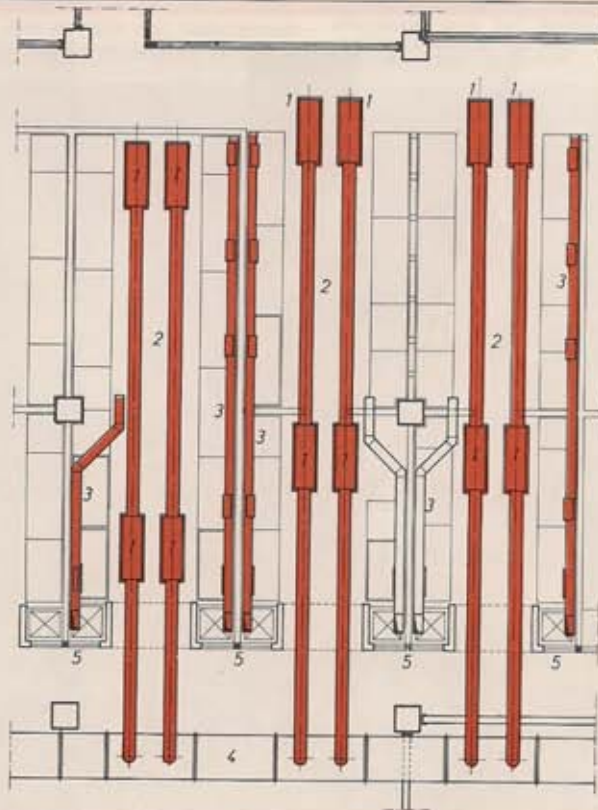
Grundriß der Laborräume im Flachbereich. Erkennbar sind Zuluft- und Abluftanlagen aus Trovidur.
